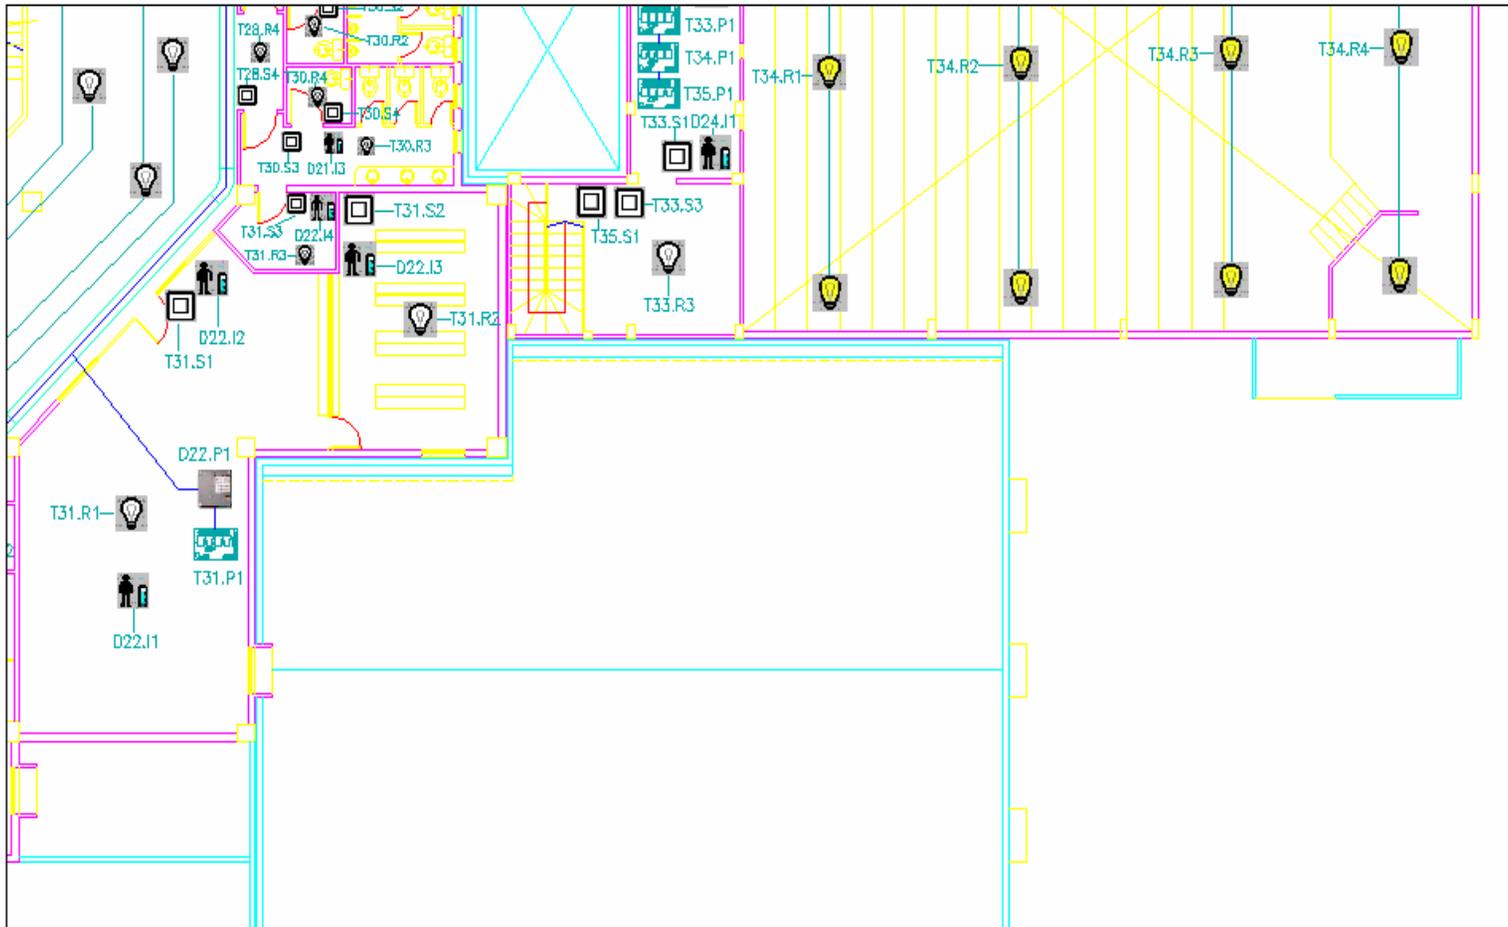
PLANO ILUMINACION PRIMER PISO SECCION 2
